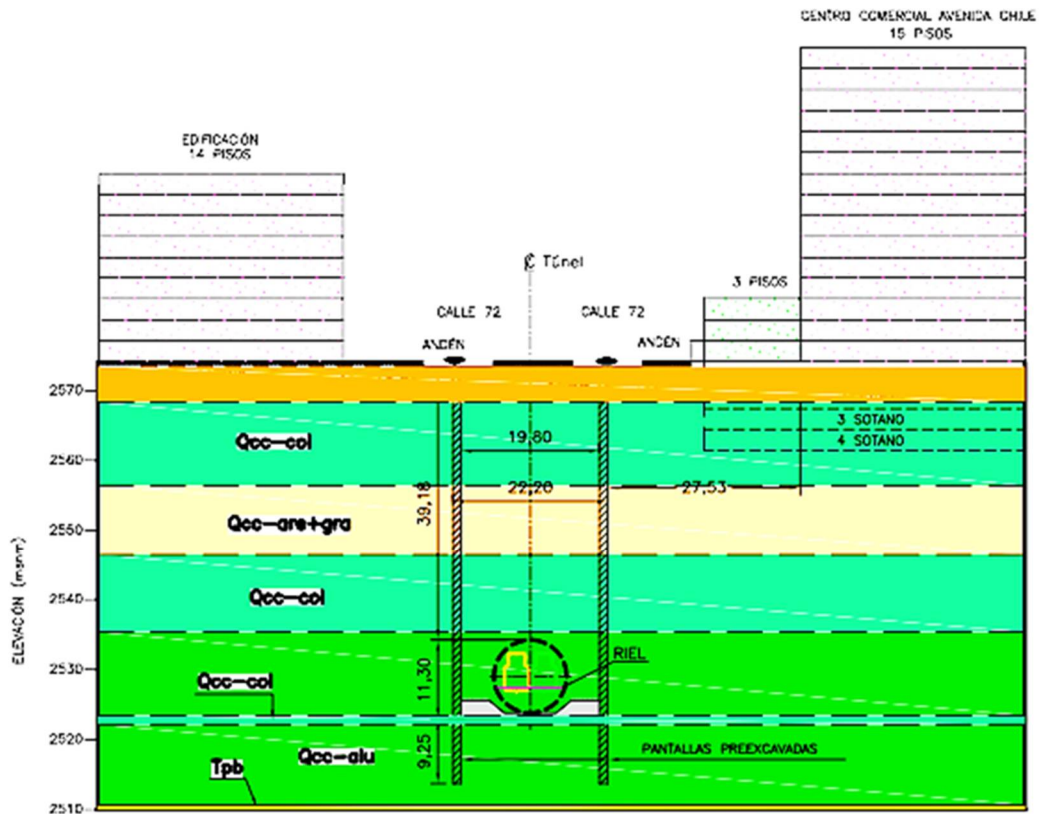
Sección transversal del pozo de salida (a la izquierda se localiza el costado sur)
